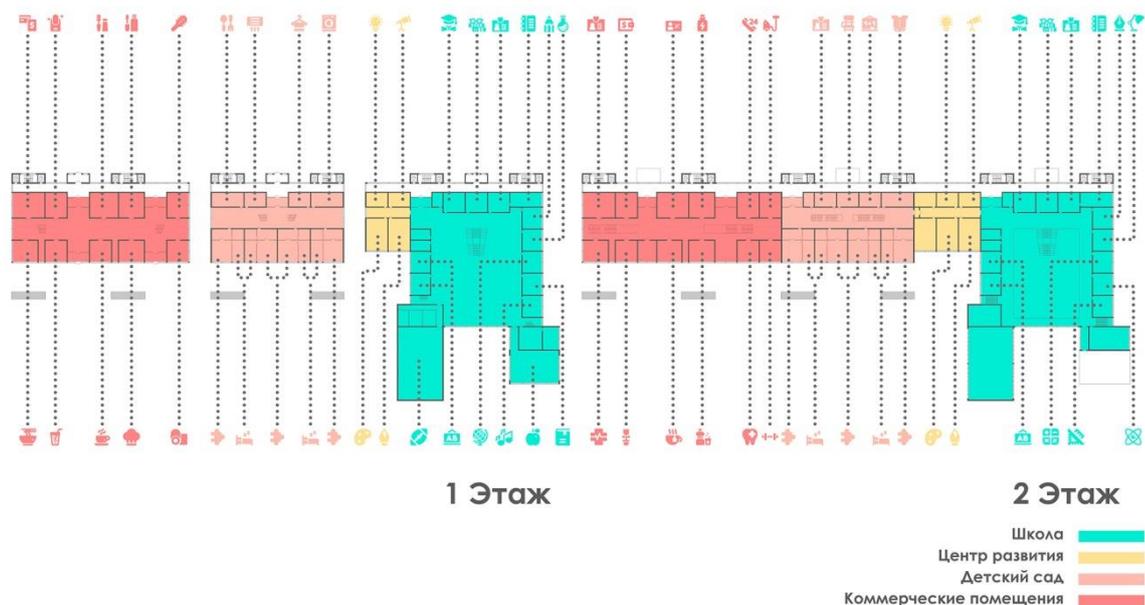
Функциональное зонирование 1-го и 2-го этажа
